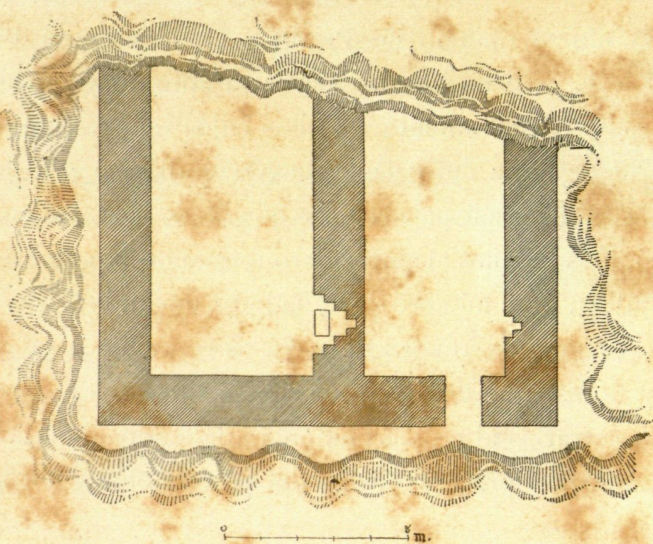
PLANTA DE DOS DE LAS CÁMARAS DE UN PALACIO DESCUBIERTO EN ABU-SHAREIN (SEGÚN TAYLOR)
